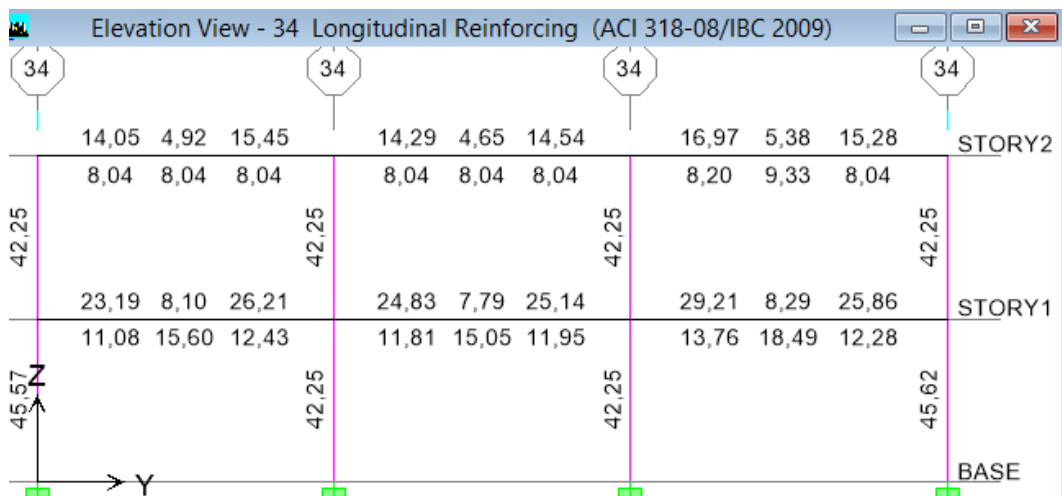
Acero en Vigas y Columnas en el Pórtico 34 – C. Quirúrgico- (NEC-11)
